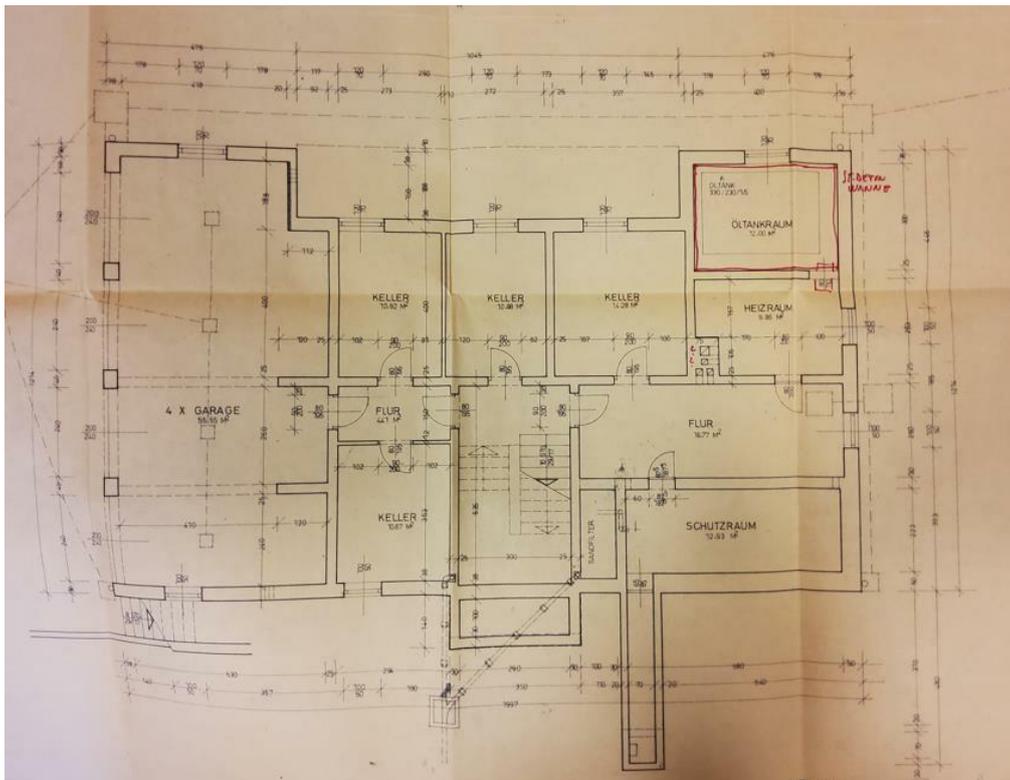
Kellergeschoß; Quelle: Einreichplan Genehmigungsvermerk vom 17.03.1970
